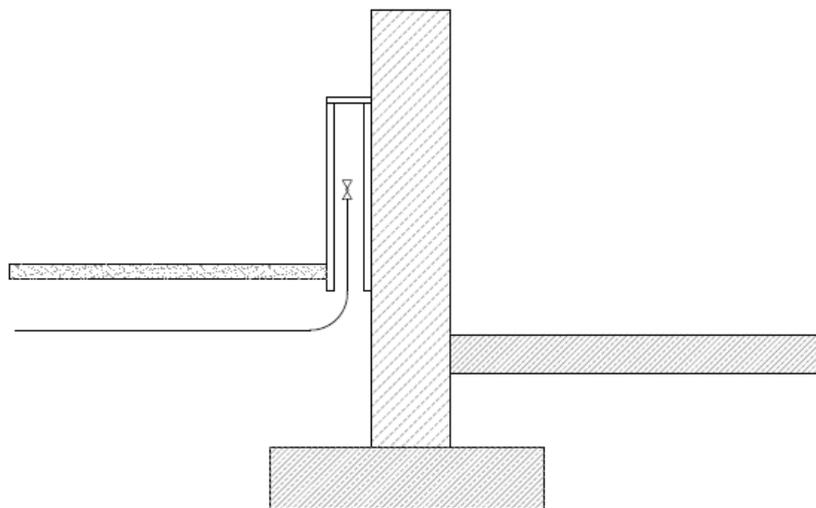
Darstellung Hausanschlusskasten mit Unterbringung an der Gebäudeaußenwand
